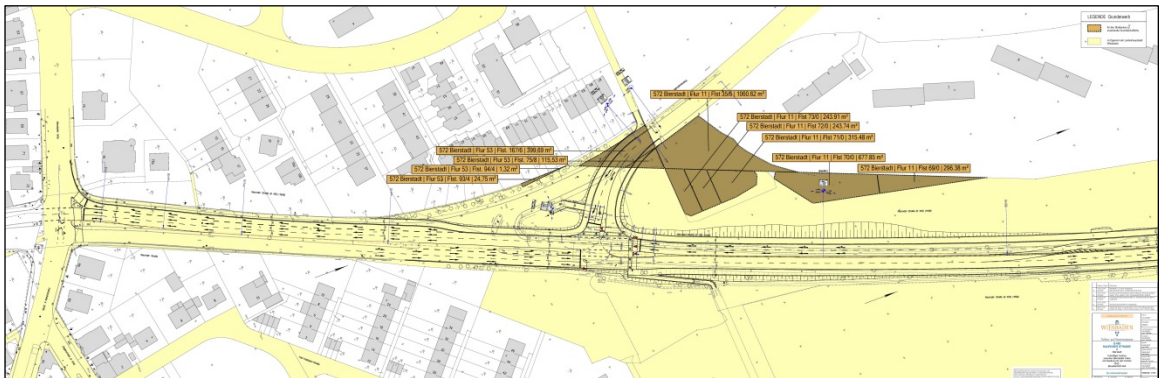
Grunderwerbsplan Bauabschnitt Süd
